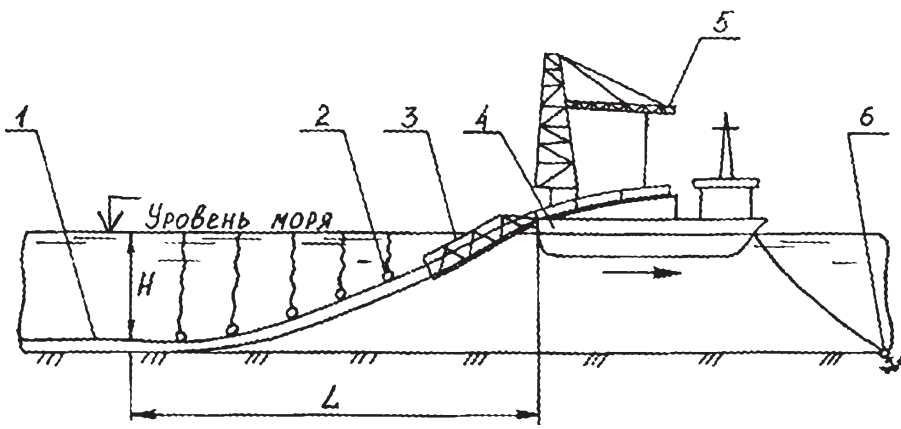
Схема укладки трубопровода трубоукладочным судном:
